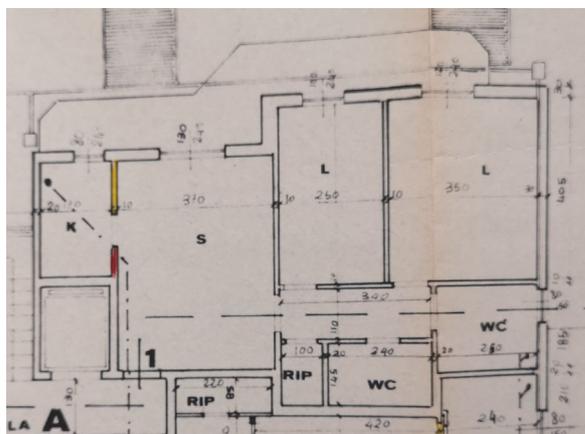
Planimetria C.E. n. 36186/88 del 27.01.1989
